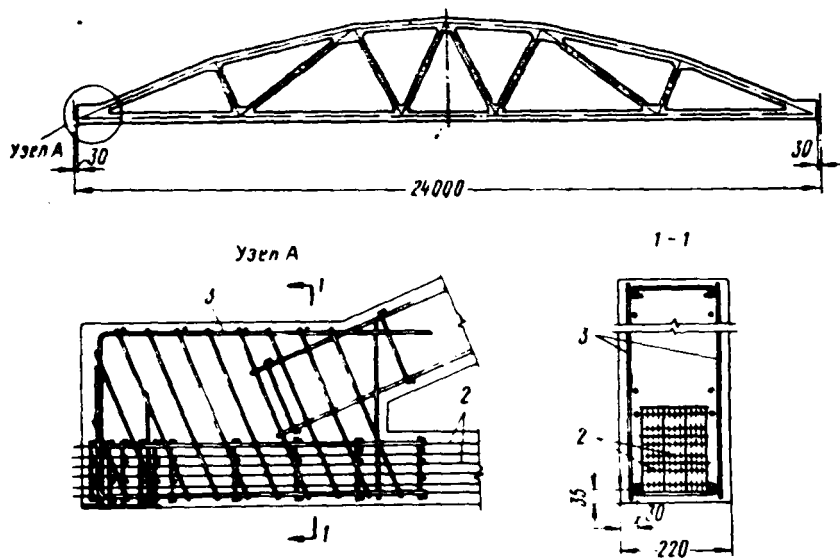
Первая цельная арочная ферма пролетом 24 м с проволочной арматурой, натягиваемой на опоры
